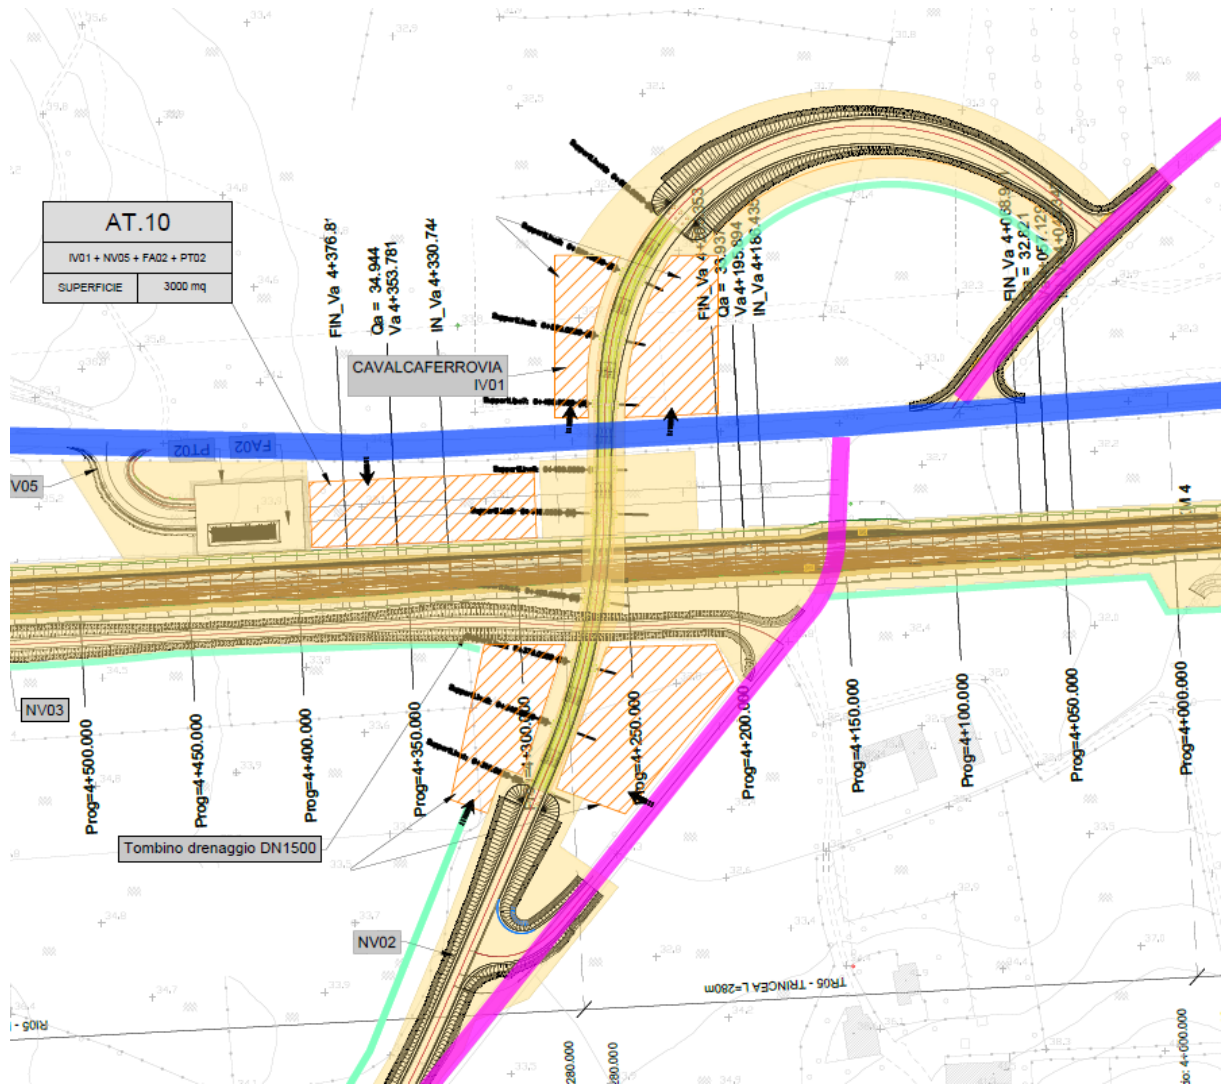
Vista in pianta dell'area di cantiere AT.10
